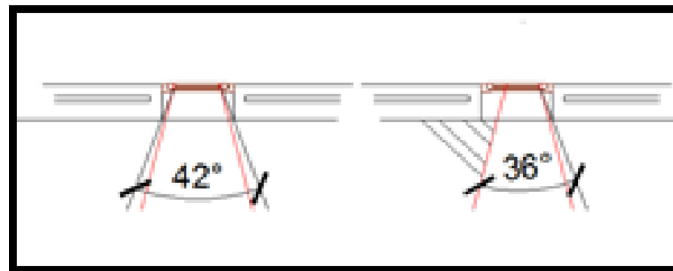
schéma sur les brises soleil des façades est et ouest, AUTEURS
